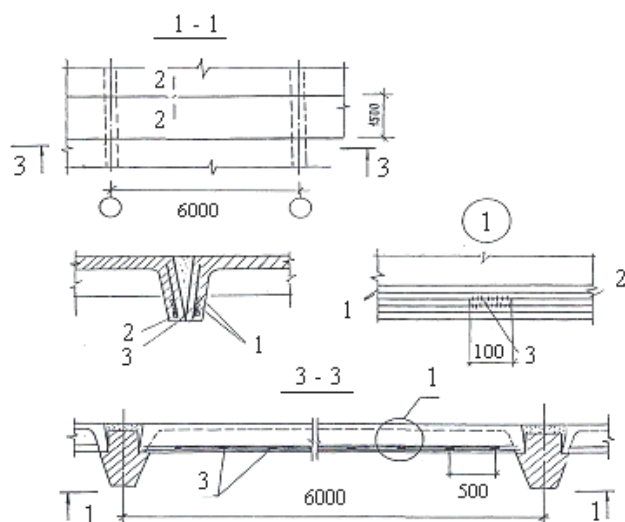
Усиление ребер сборных плит перекрытия с помощью дополнительной арматуры:
